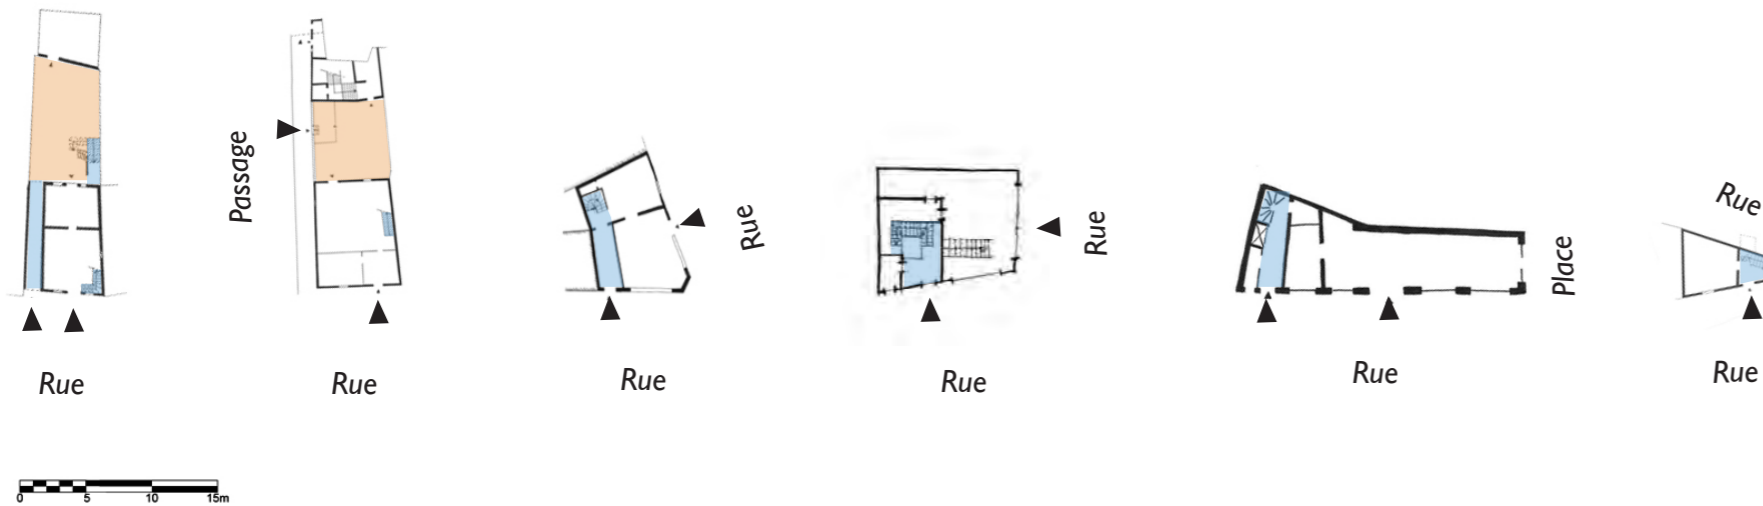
Plans rez-de-chaussée des maisons commerçantes et de faubourg
